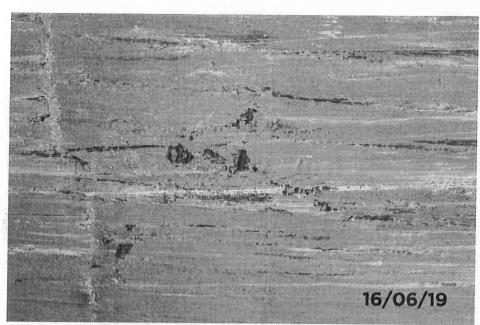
Detalhe de armadura exposta por vazios existente no concreto.
